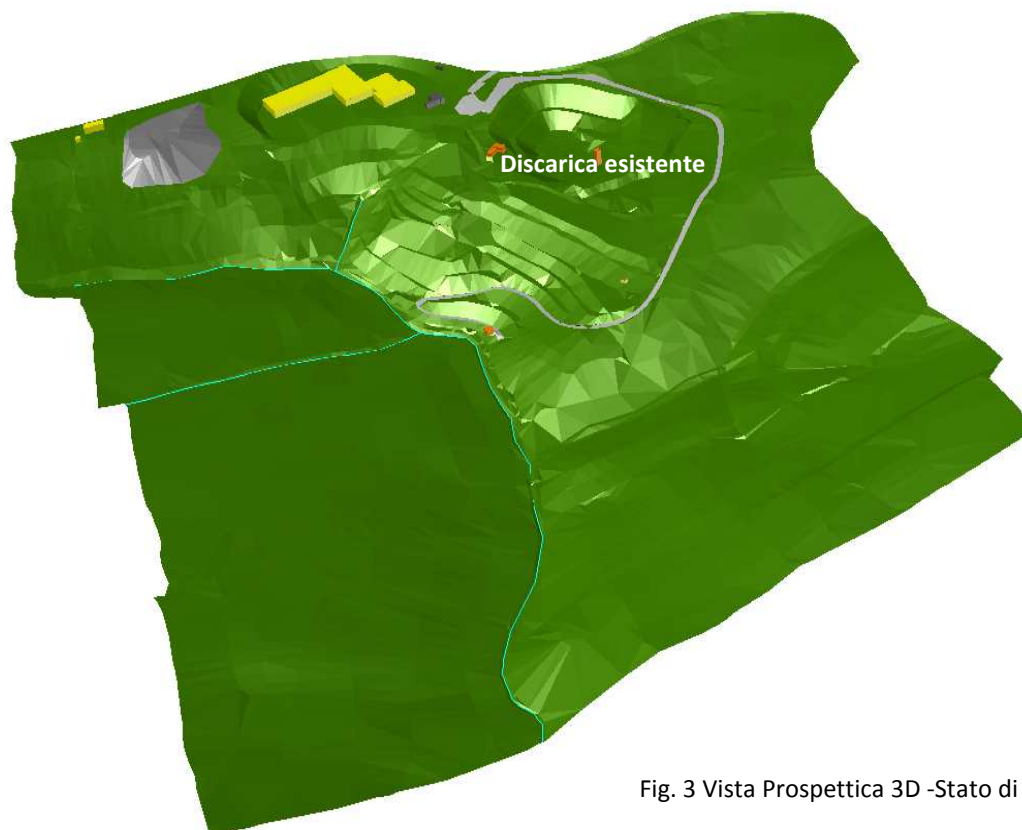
Vista Prospettica 3D -Stato di Fatto
